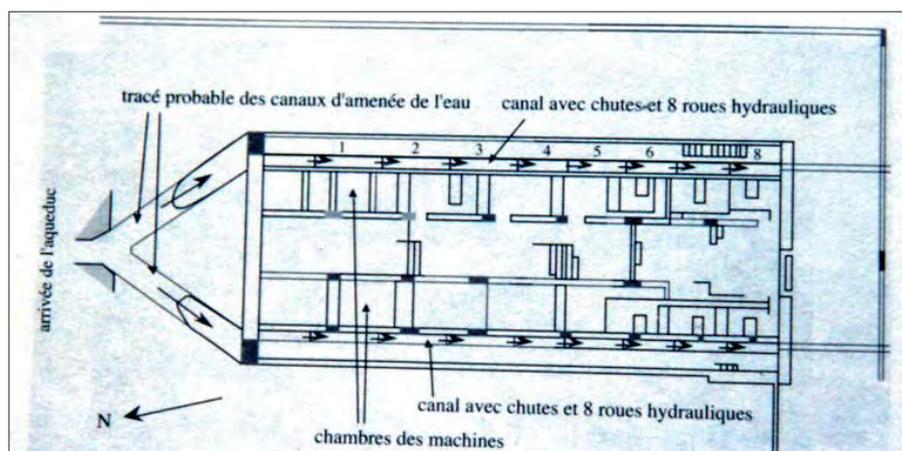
Schema generale del sistema in pianta (Viollet, 2000).
